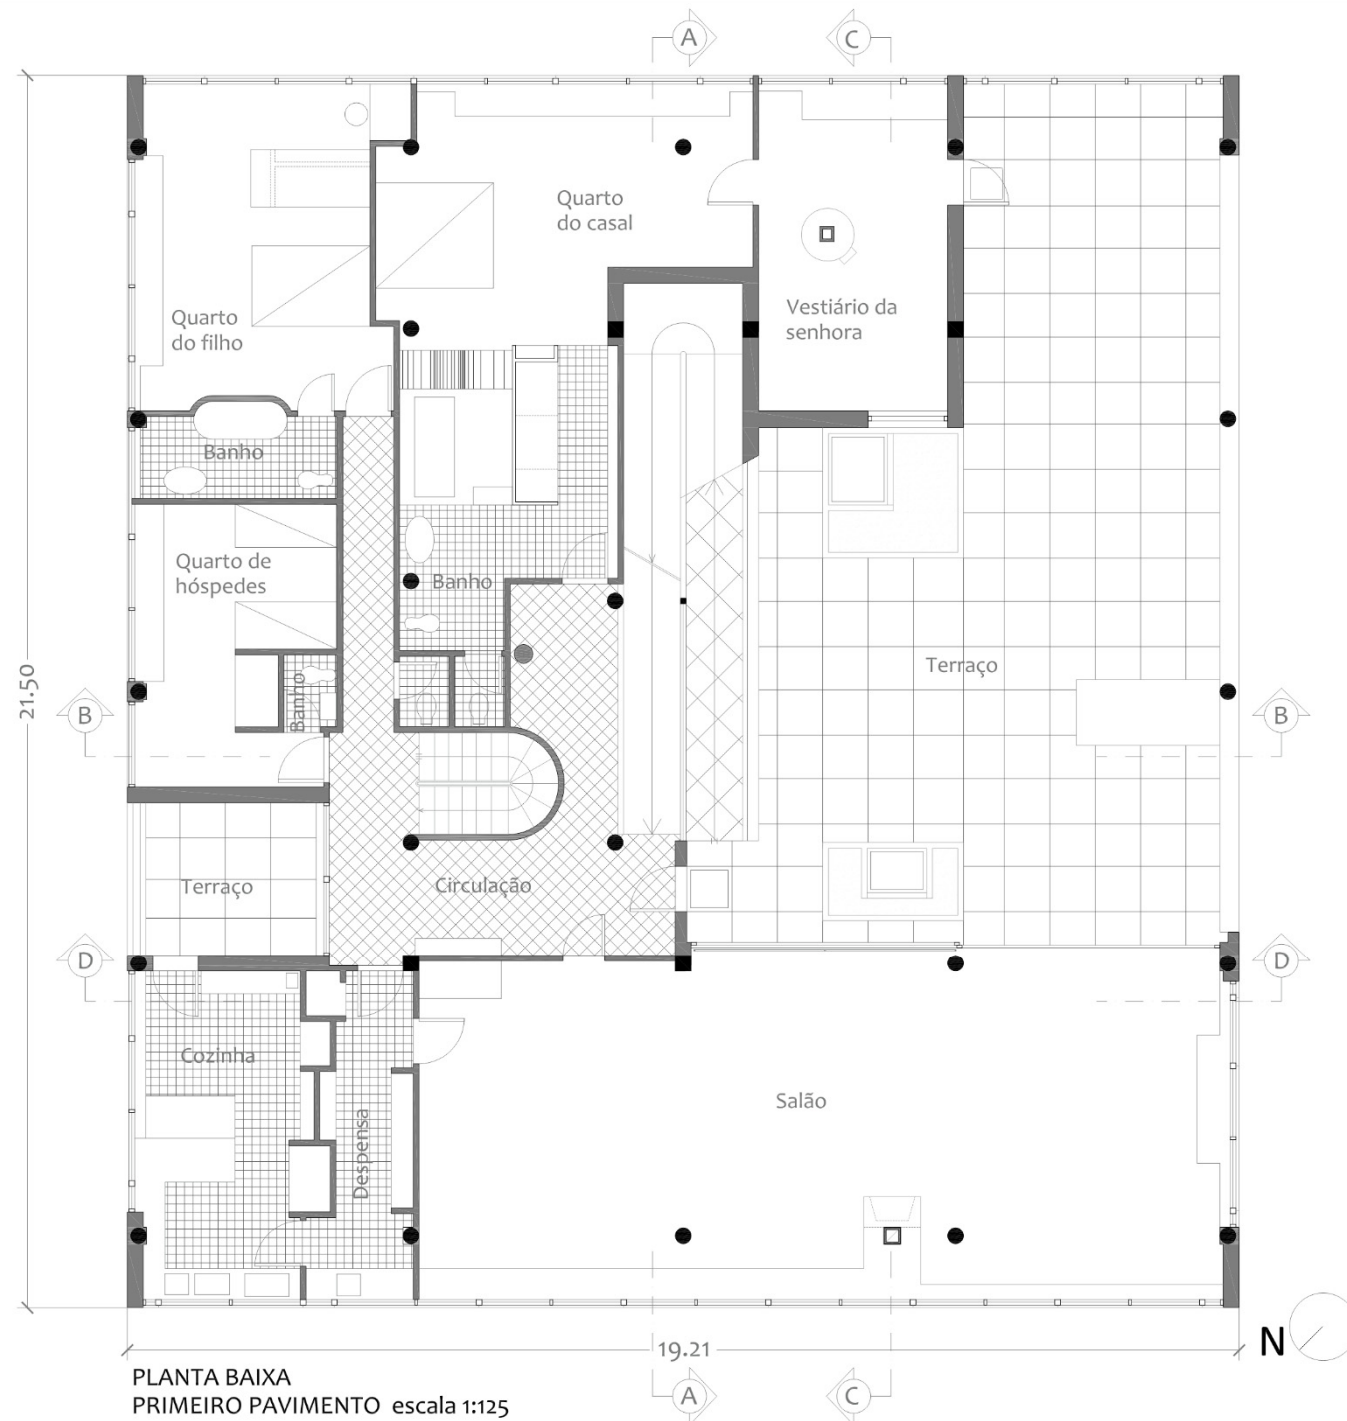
Vila Savoye, projeto construído. Planta baixa do primeiro pavimento. Fonte: Autora, 2016.
